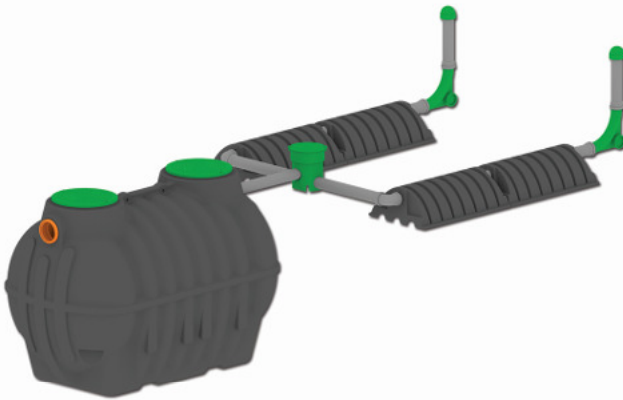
Przykład instalacji zbiornika BOLT 2,5 z drenażem rozsączającym
